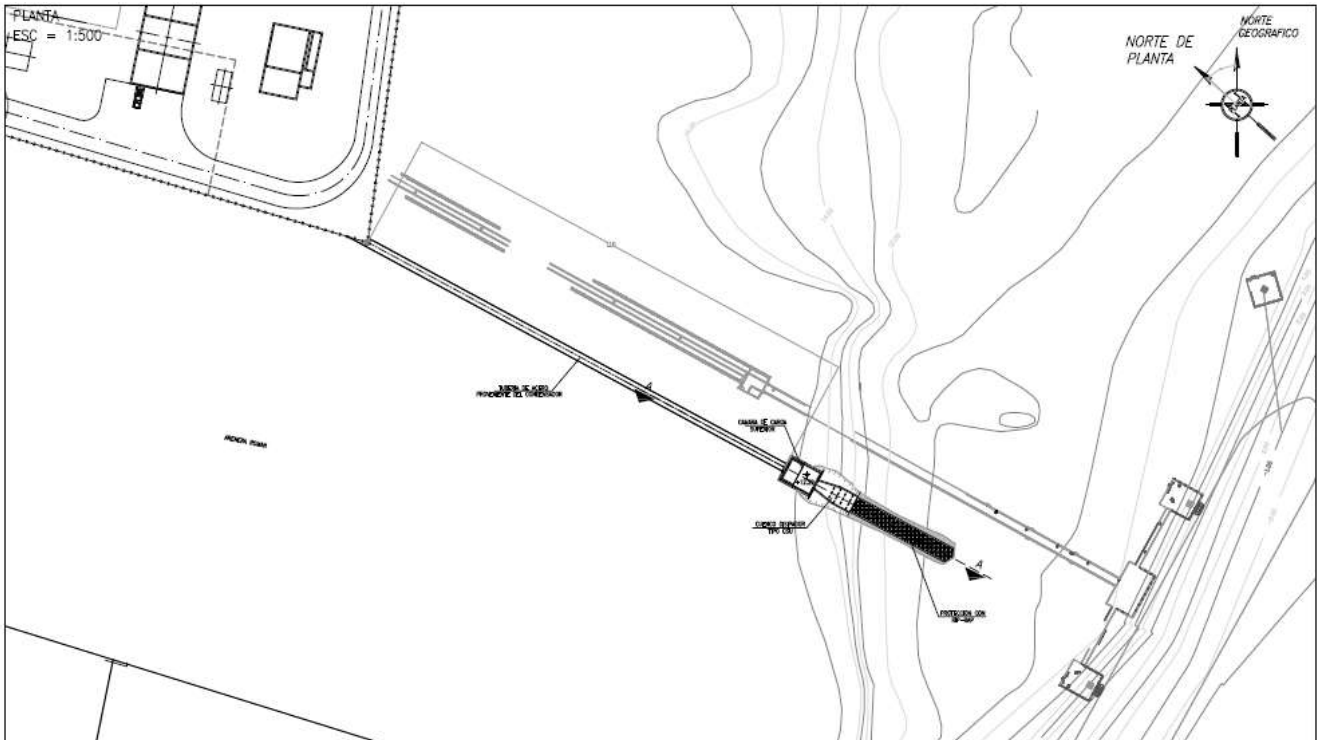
Esquema de las obras de descarga con Disipador tipo CSU de la Central Termoeléctrica. Vista en planta.
